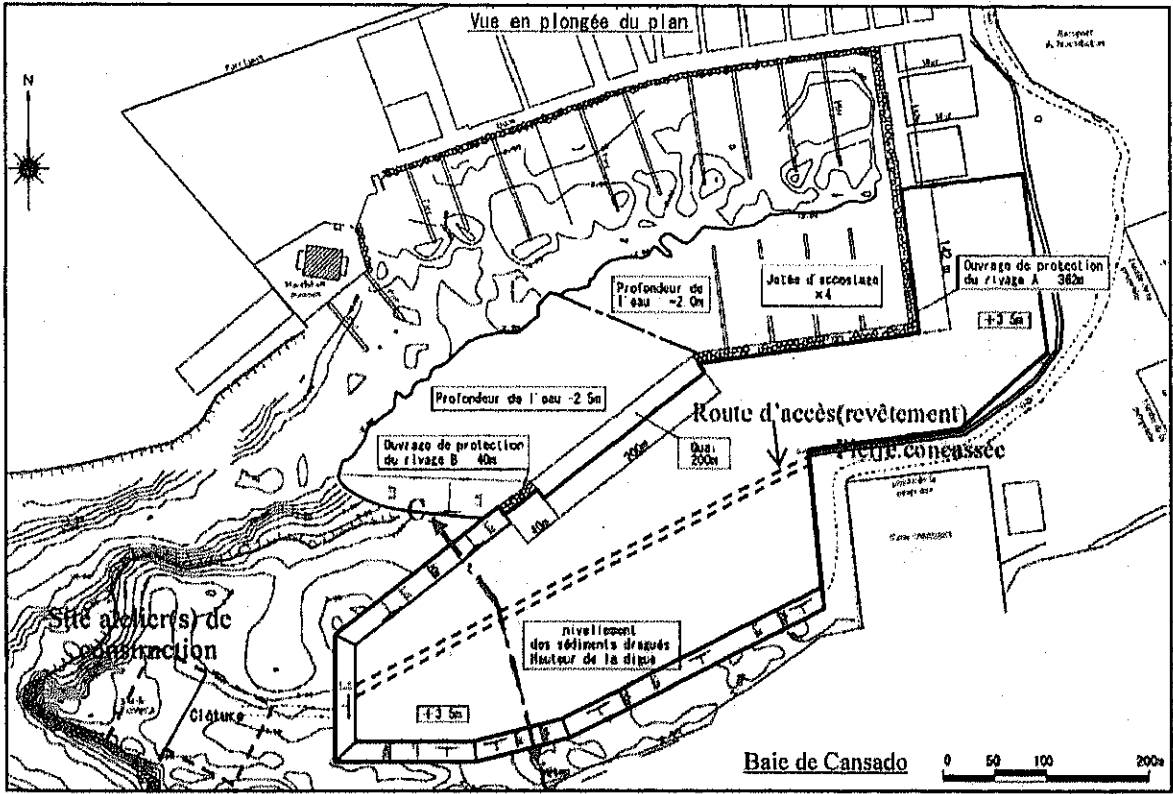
(11) Plan de terrain planifié pour le nivellement à l'aide des déblais de dragage
